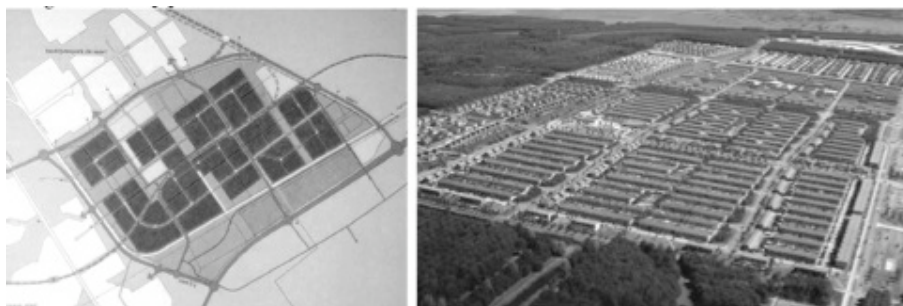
La visione strutturale del distretto Almere Buiten e vista aerea del quartiere (fonte: Zhou e Commandeur 2009)
